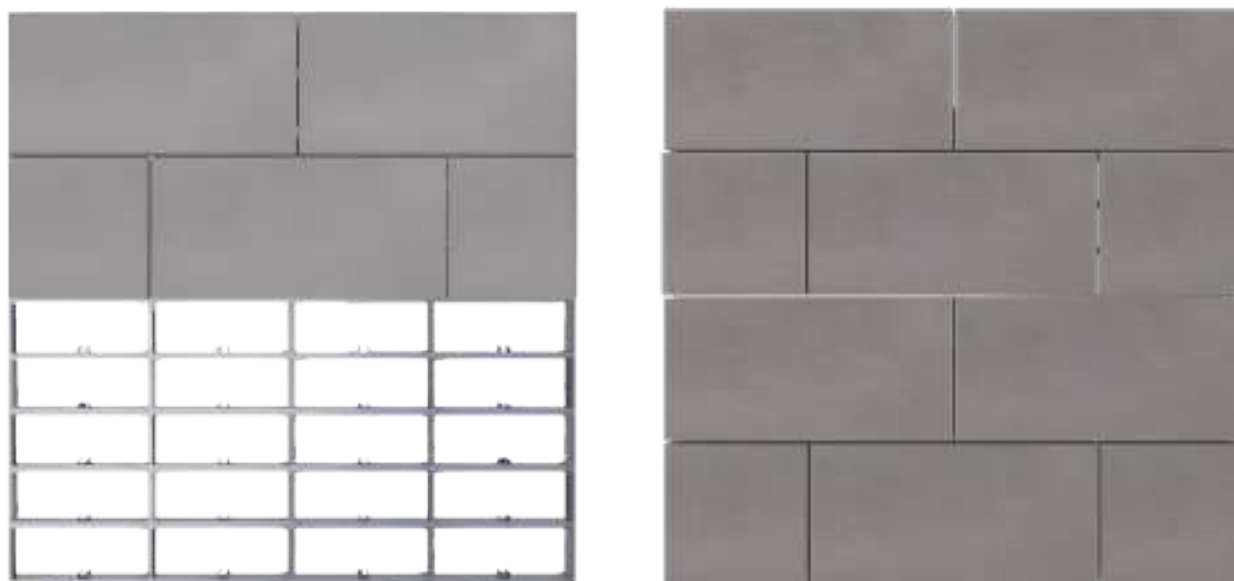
Instalação dos painéis sobre estrutura de aço pesado.
